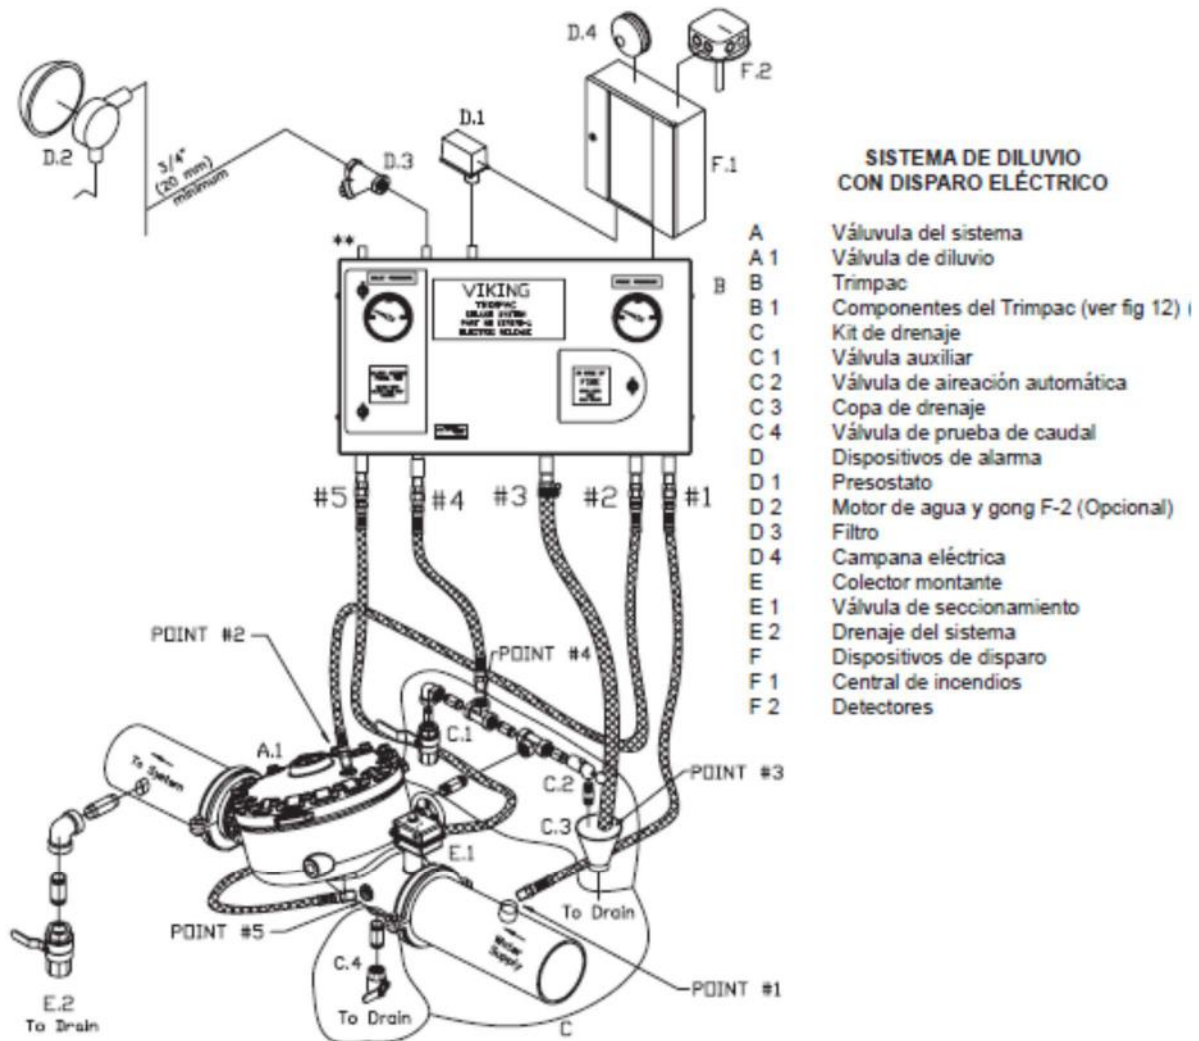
Sistema diluvio con disparo eléctrico. TRIMPAC para válvula 6" horizontal
